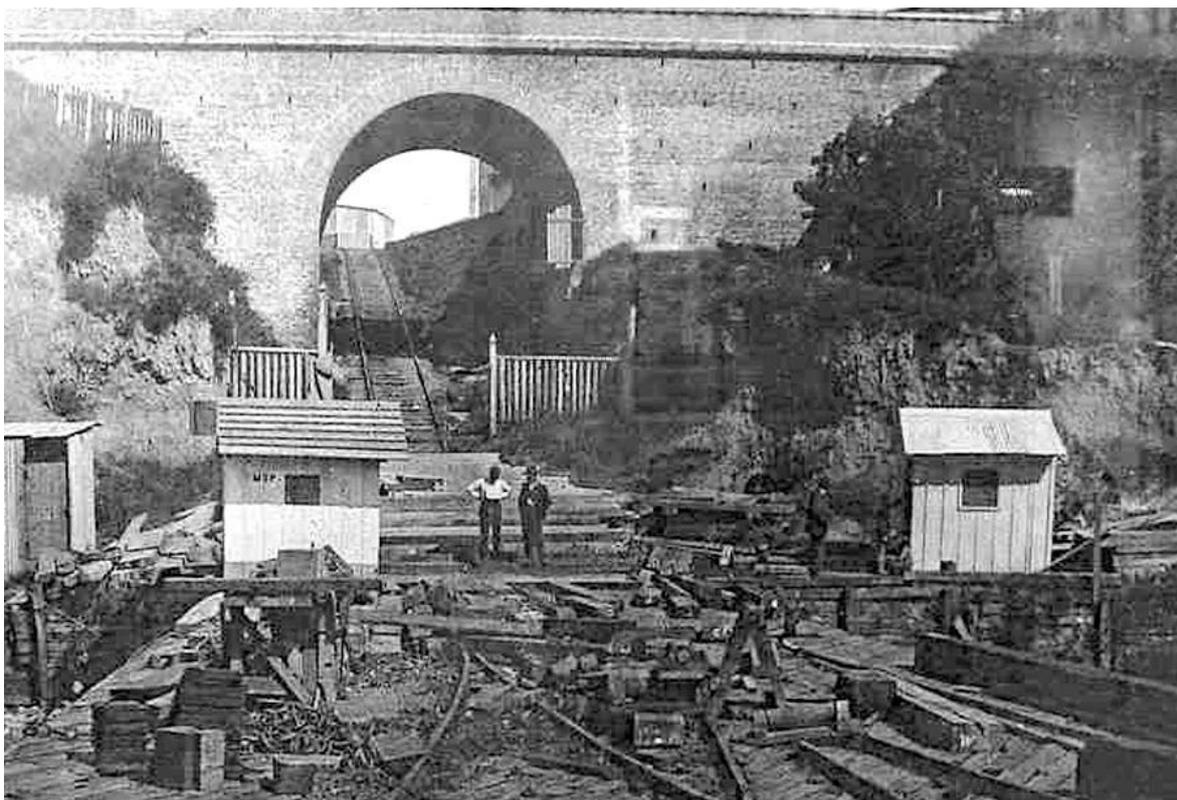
Muelle Casado. Fuente: Foto Archivo. Museo Nacional Ferroviario. Circa 1888.
